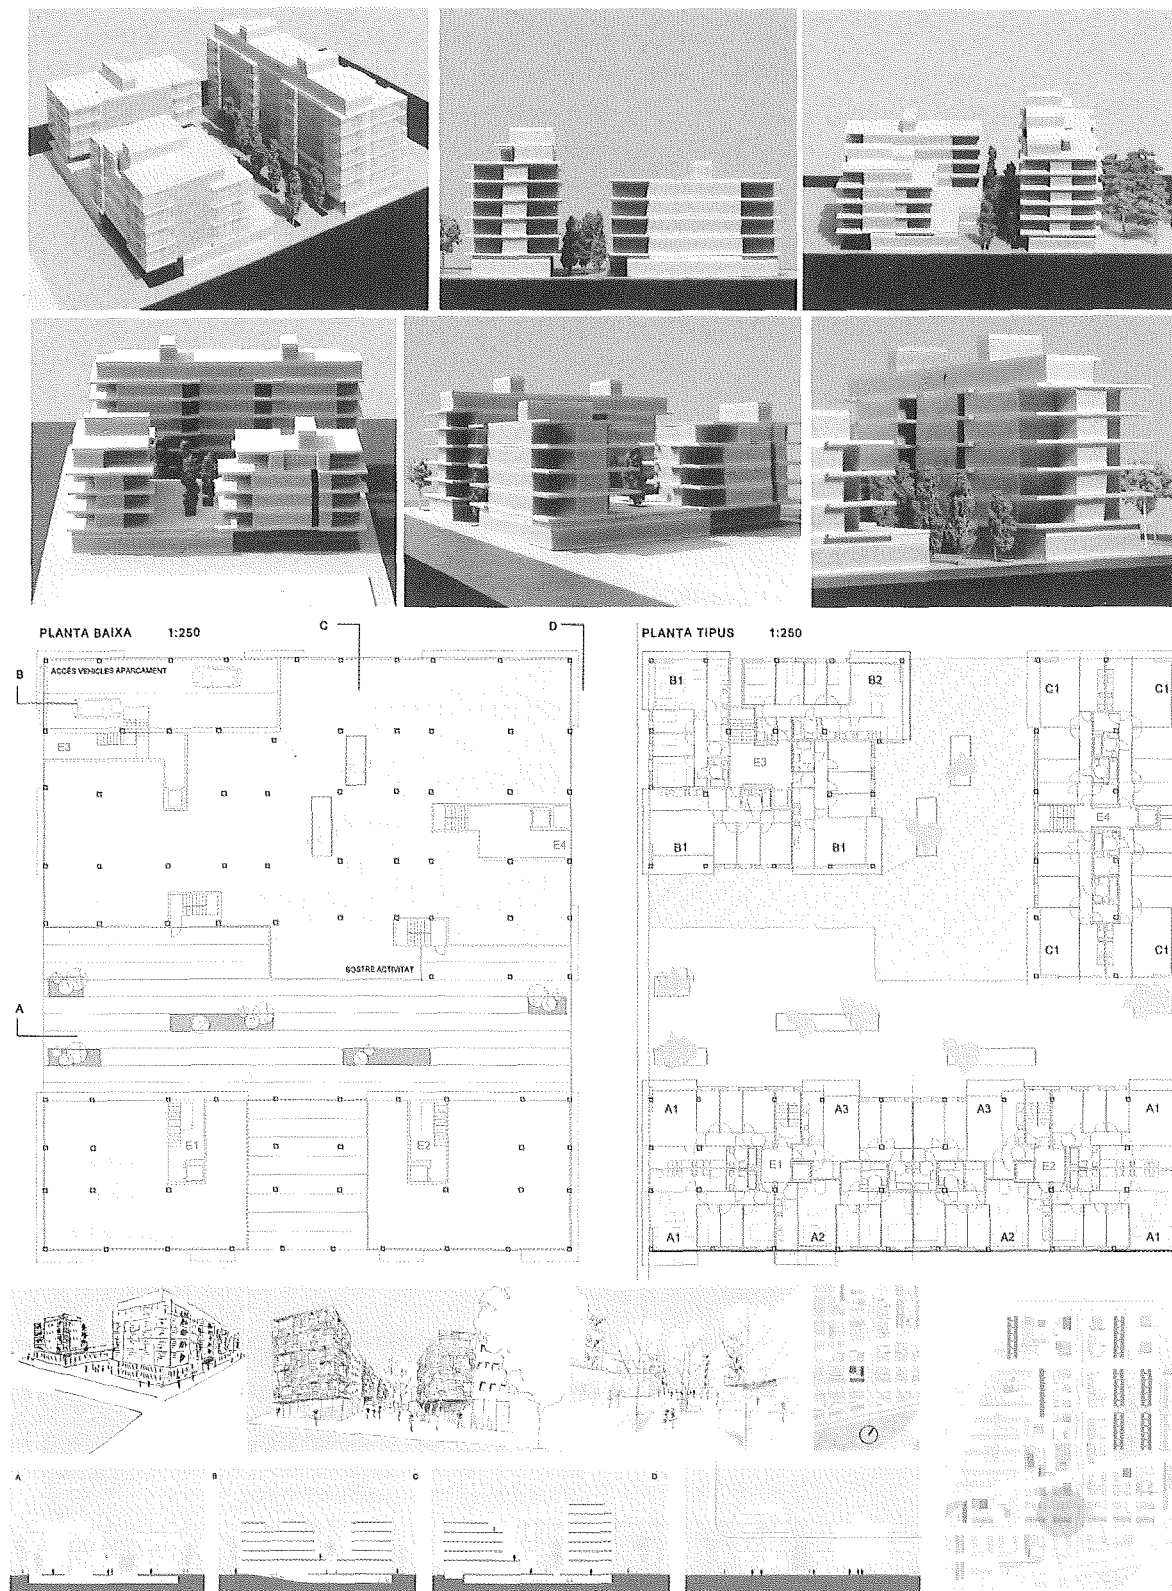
Proyecto para la manzana R-12 de RGA Arquitectos. Axonómicas, planta baja, planta tipo, esquemas y secciones, localización.
